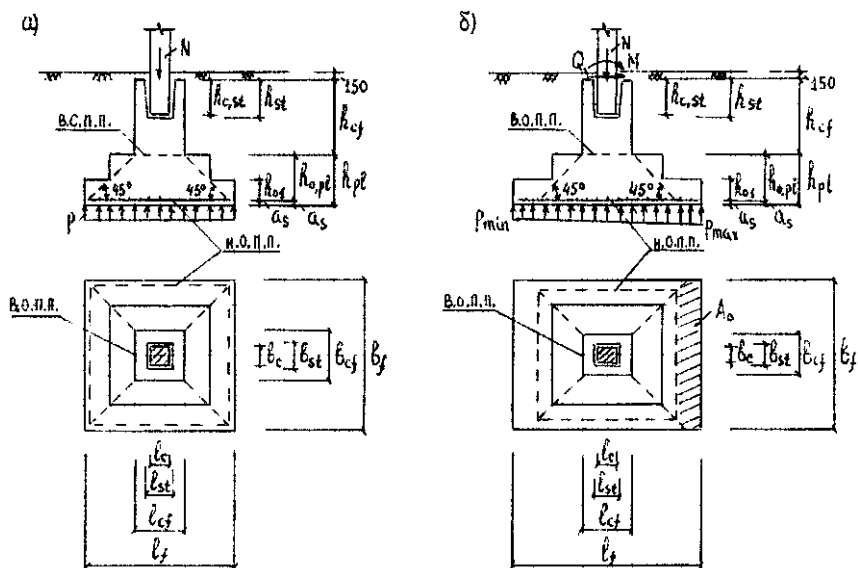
Схемы образования пирамиды продавливания при стаканном сопряжении сборной железобетонной колонны с высоким подколонником: а – центрально нагруженный фундамент, б – внецентренно нагруженный фундамент
